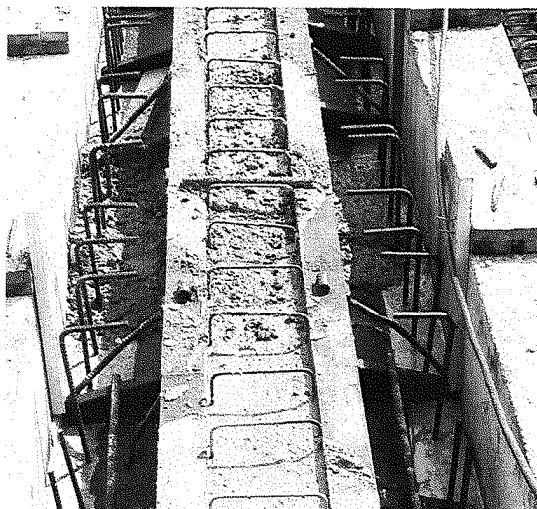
, 12 y 13 – Losetas pretensadas prefabricadas
